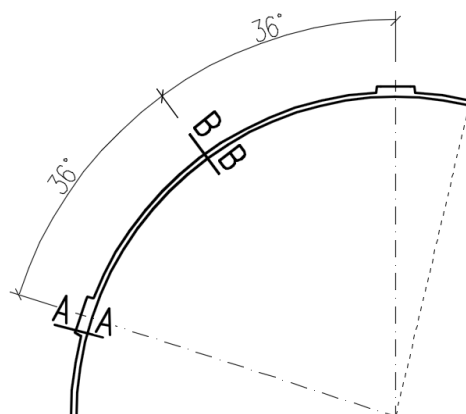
Widok modelu zbiornika z 10 pilastrami.
